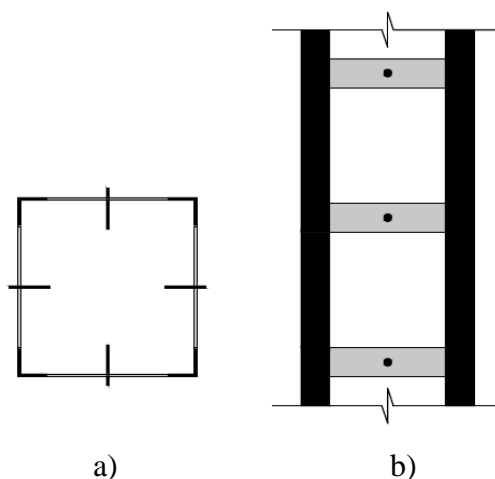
Ancoragem das cintas metálicas com buchas: a) corte; b) planta
